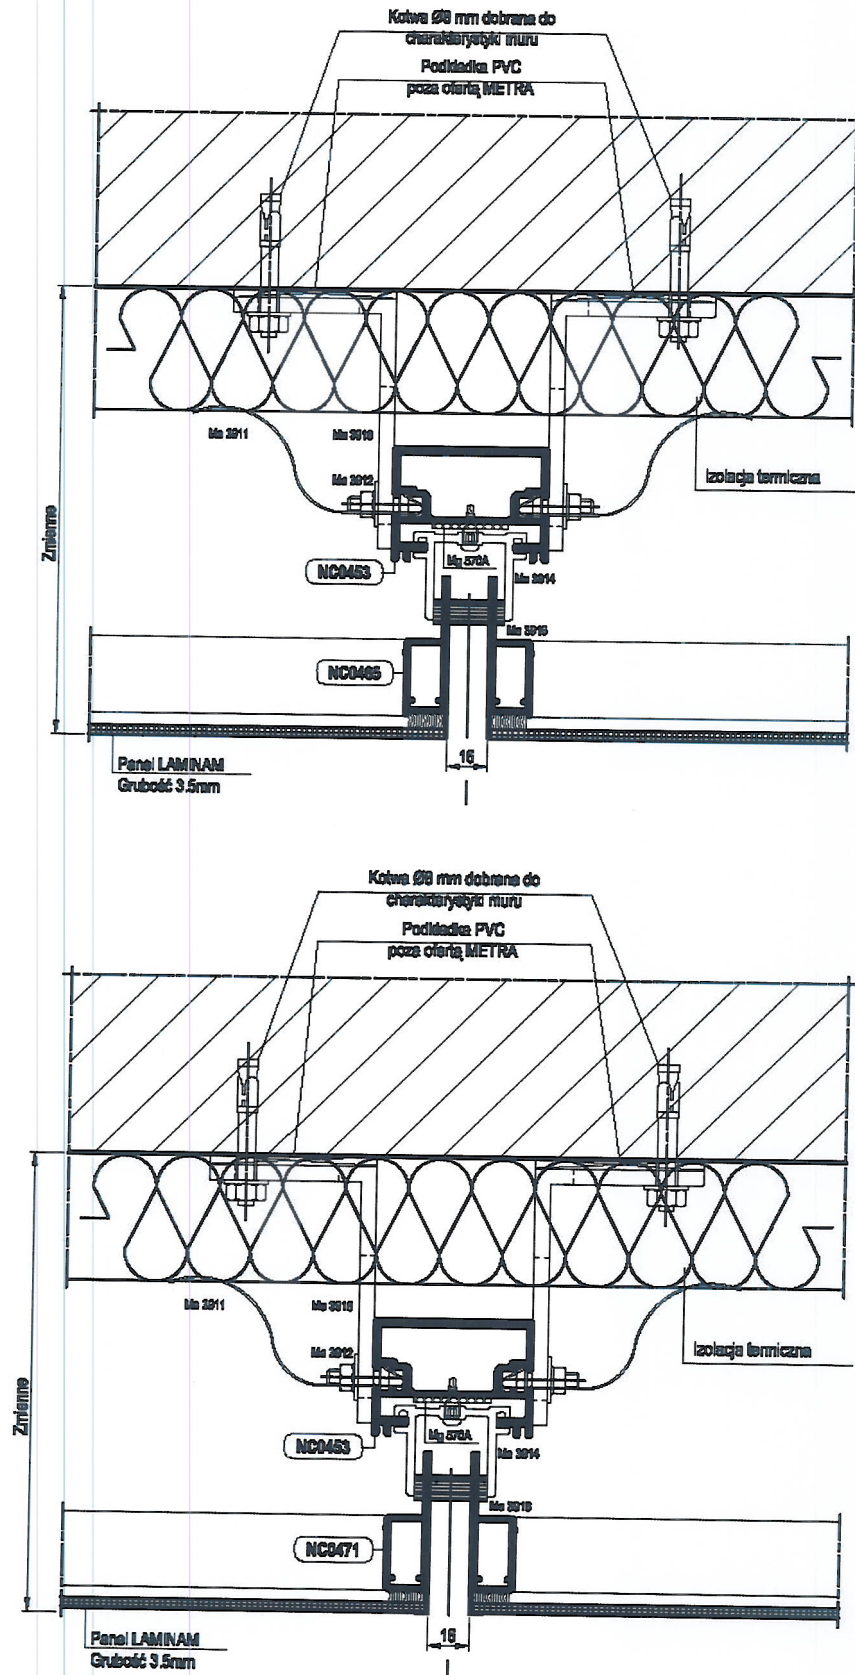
Przykłady zastosowania elementów podkonstrukcji systemu METRA® URANO WALL
